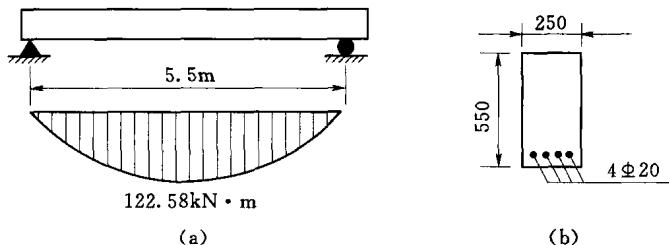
钢筋混凝土梁、内力图及截面配筋图
